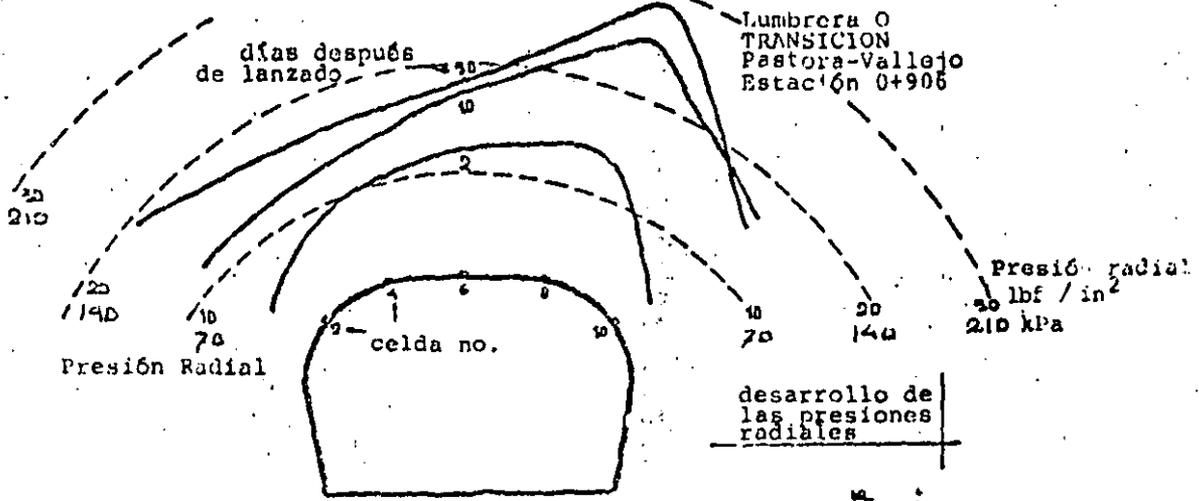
Distribución de la presión de contacto en concreto lanzado.
